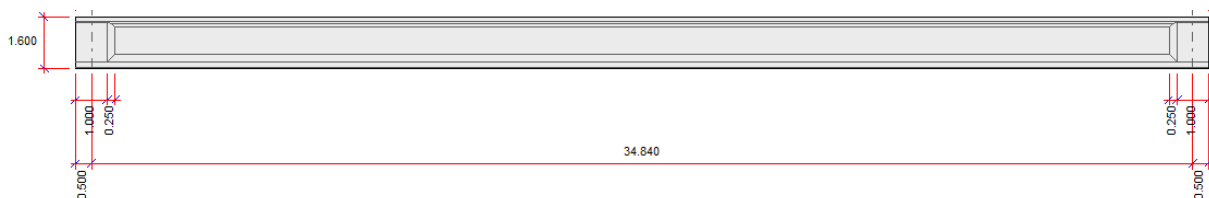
Alzado de viga. Fuente: IDOM-DEHC.
